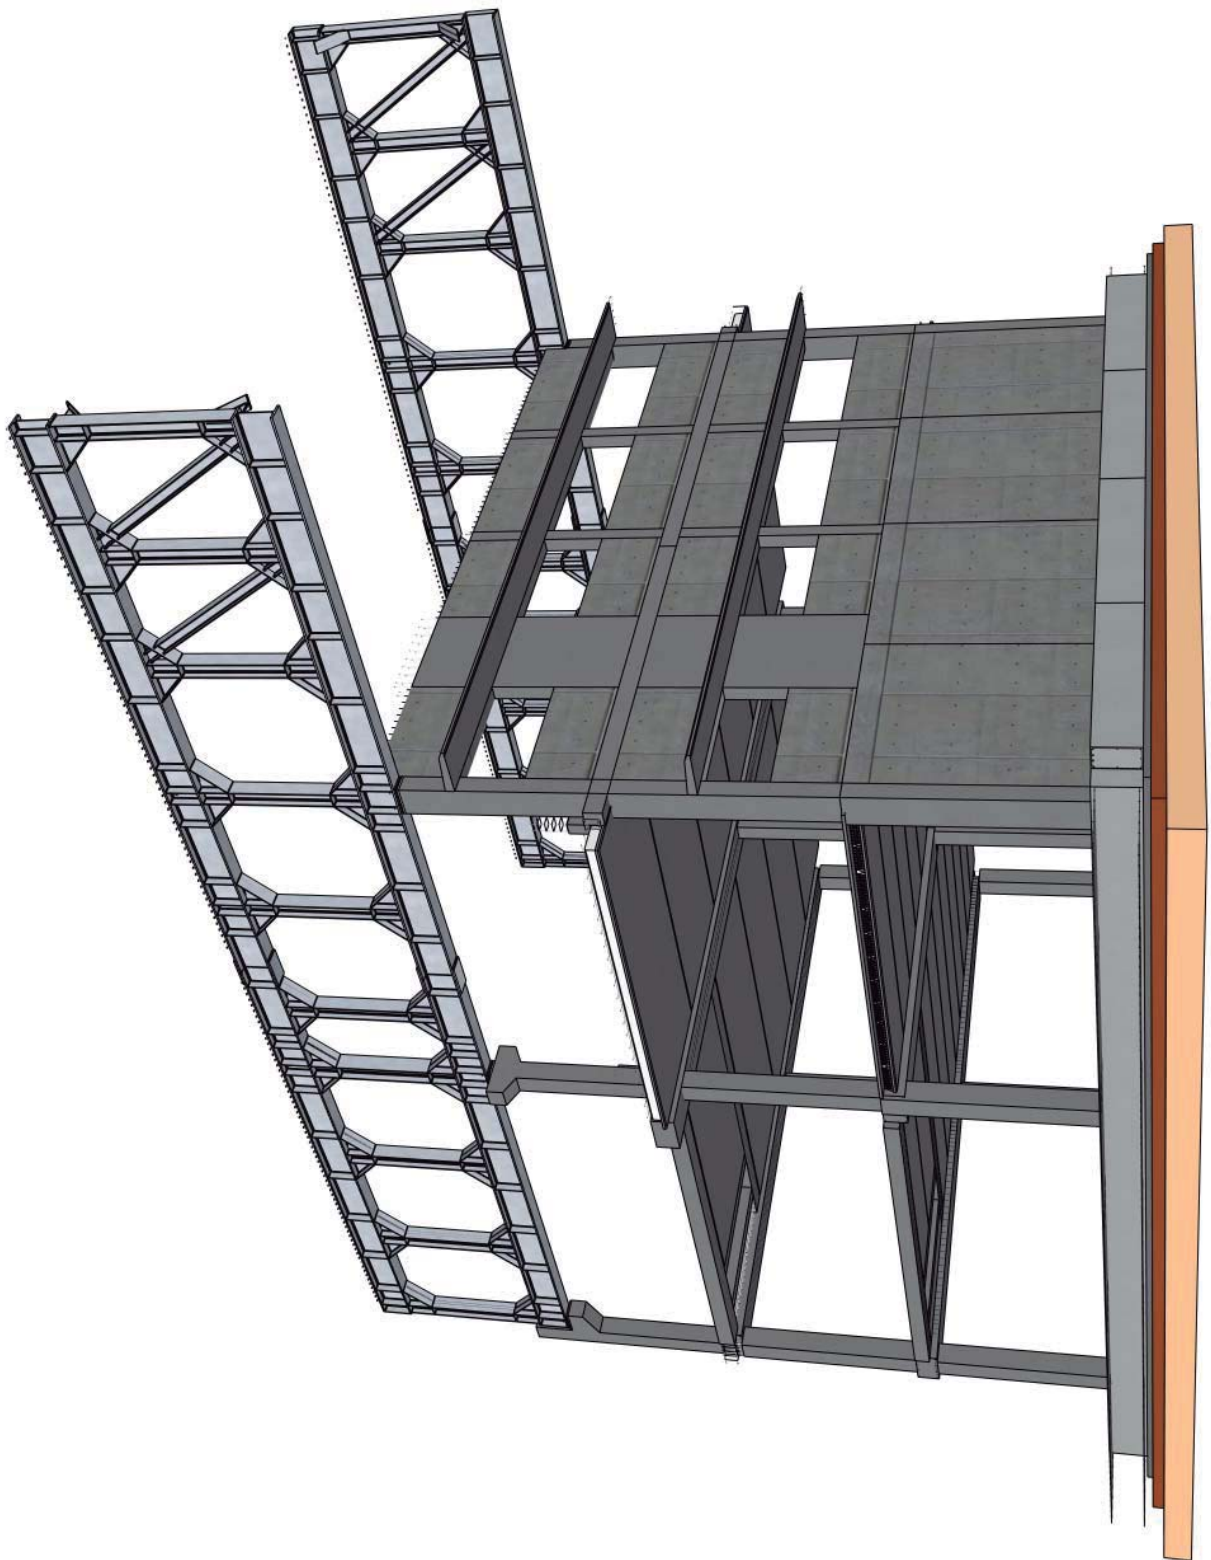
Colocación de los dos tramos exteriores de la estructura metálica del voladizo.
